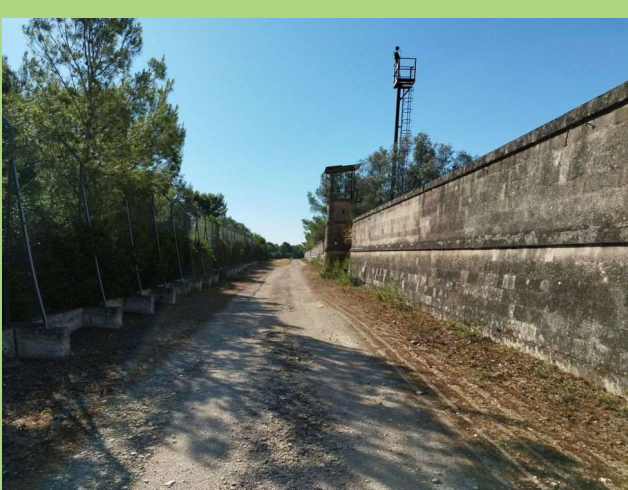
Torretta di avvistamento e muro perimetrale della ex-polveriera.
